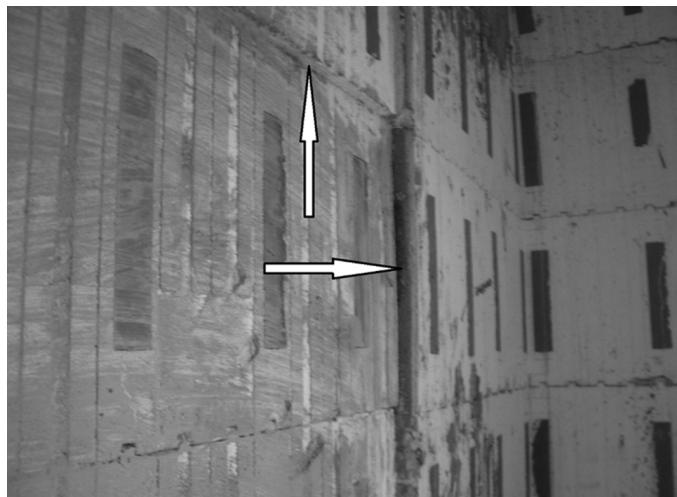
Внешний вид повреждений возведенной монолитной железобетонной стены в несъемной пенополистирольной опалубке
